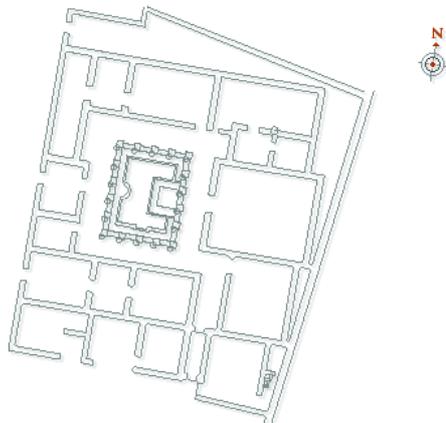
Planta da Casa dos Esqueletos de Conimbriga
